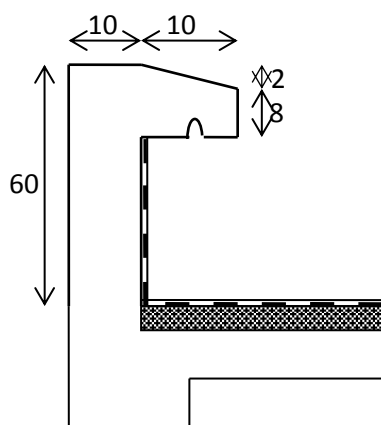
les dimensions d'acrotère pour terrasse inaccessible.
